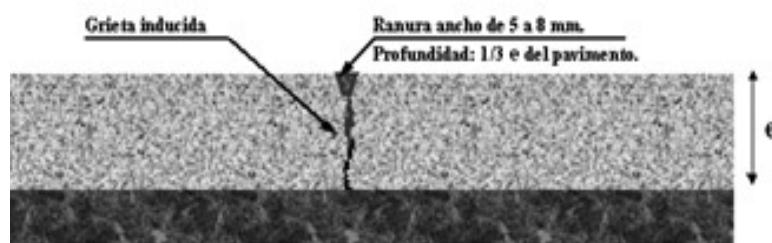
Detalle de junta transversal en Pavimento hidráulico
